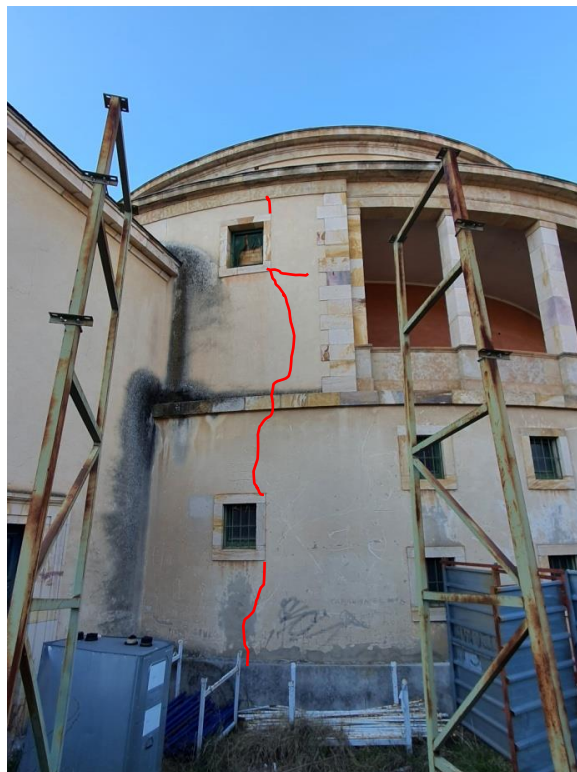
Vista general donde se observan una fisura vertical, y moho y hongos por la escorrentía del agua por la fachada.
